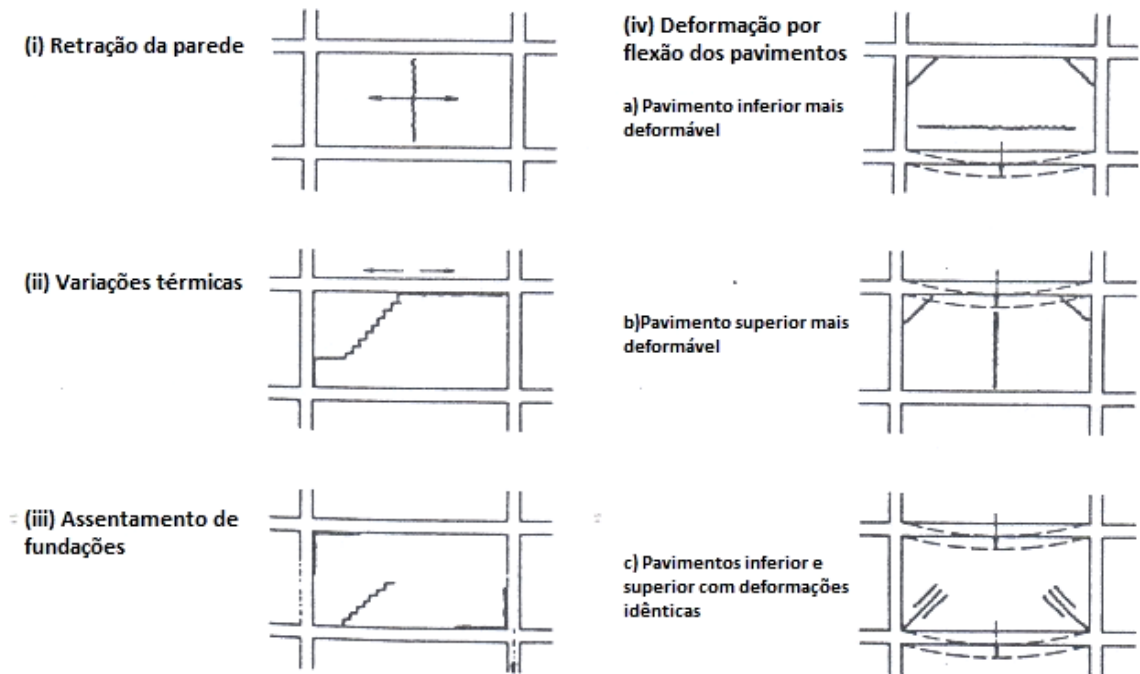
Tipos de fissuras e respetivo esquema em paredes não-estruturais [12]
